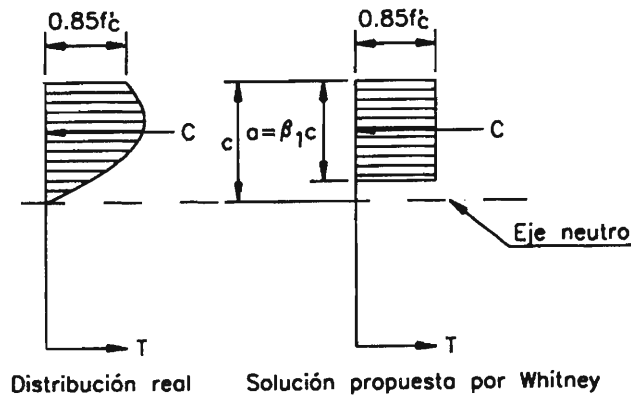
Distribución de esfuerzos en el concreto en compresión de la viga
